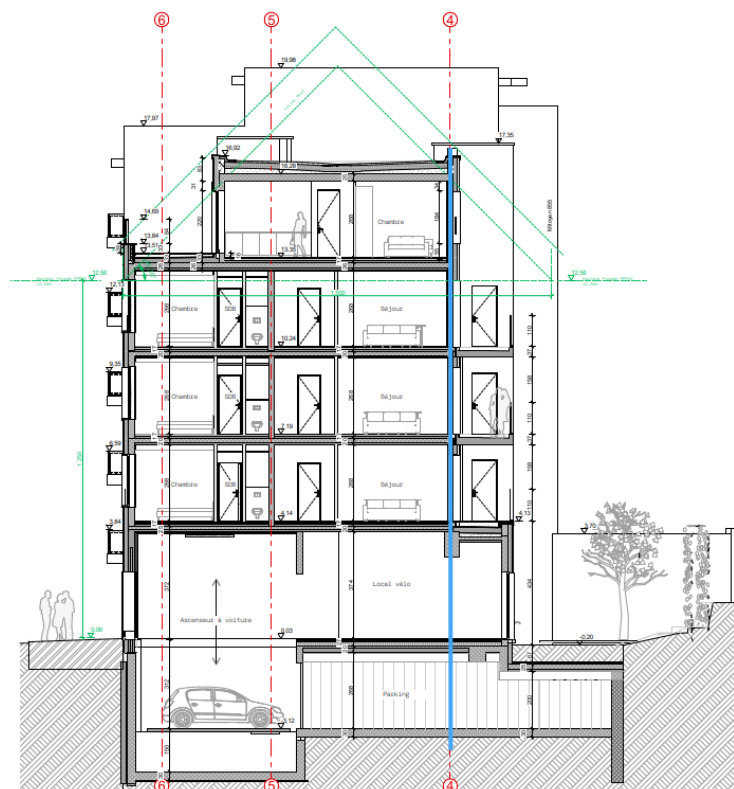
Alignement de la façade avec la structure, extrait des plans d'architecture
